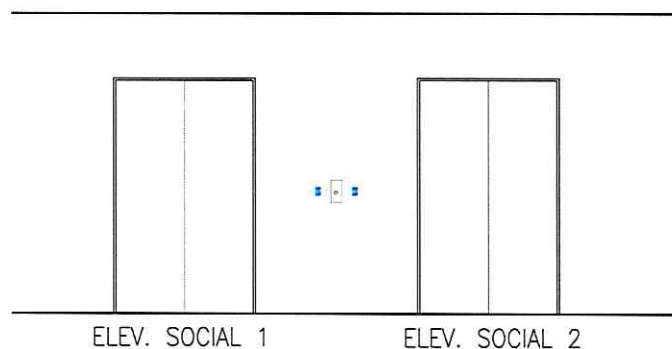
Vista Frontal dos elevadores para aplicação da placa de sinalização em Pictograma e Braille.
